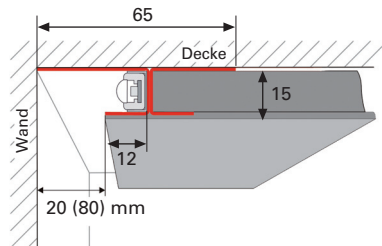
Decken-Lichtvoute mit U/20 oder U/80 Profil Decken-Montage
